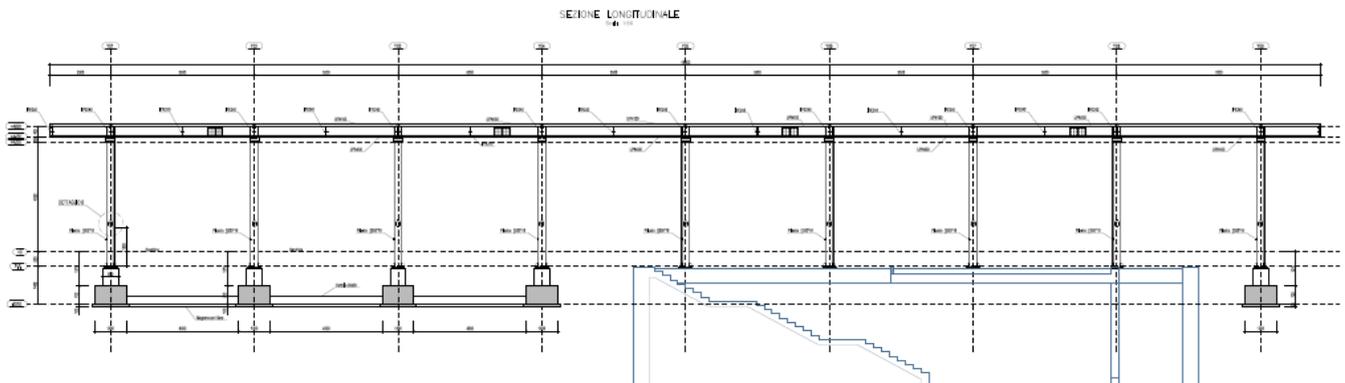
Pensiline – Sezione longitudinale - Pensilina Nord
